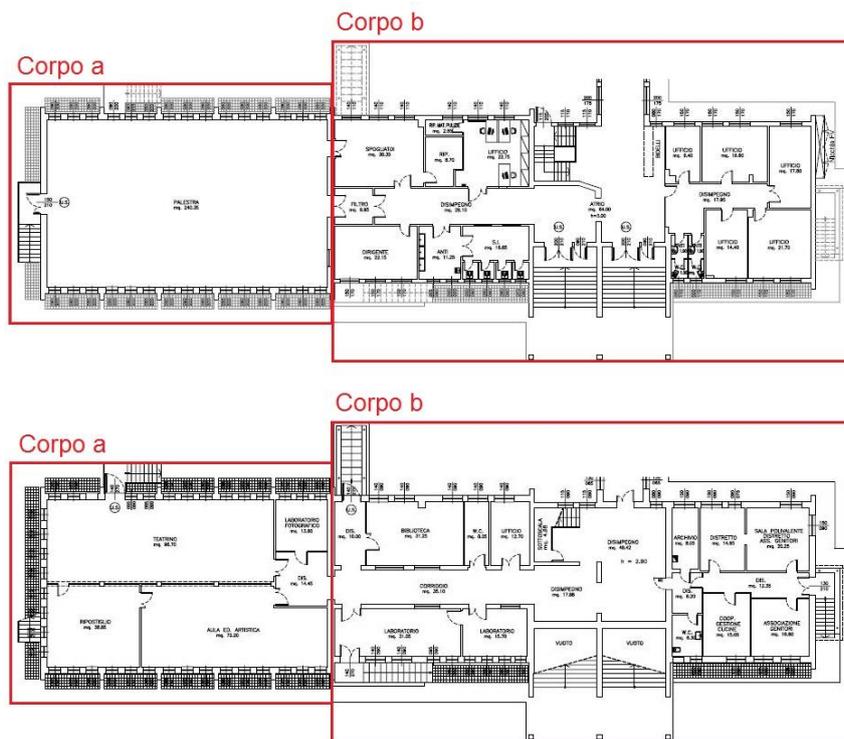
Suddivisione Corp1. In alto pianta piano rialzato, in basso pianta seminterrato.
